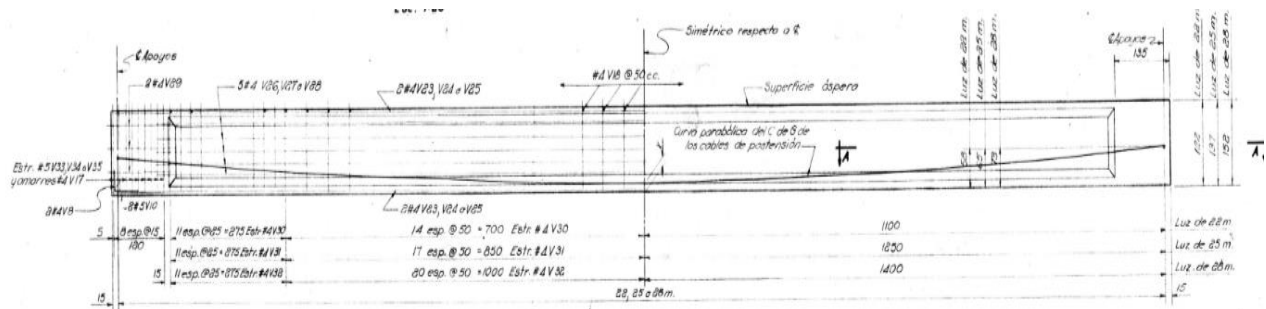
Acero de refuerzo y distribución de tensores para viga simple de la viga principal del río Kooper en el tramo central. Fuente: Planos disponibles para río Kooper en el sitio de SAEP, 2016.
